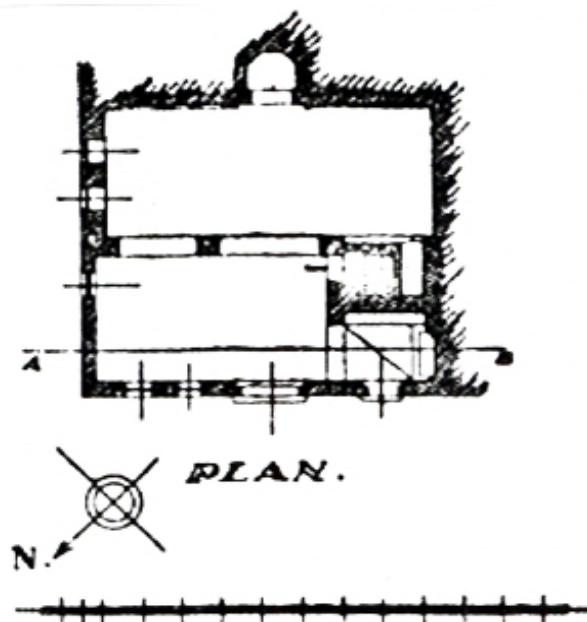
مسقط أفقى لمسجد الزهر بفاس الجديد.
